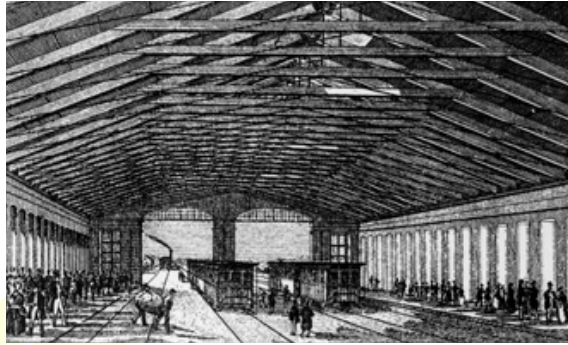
Hölzerne Dachkonstruktion der Bahnsteighalle.
